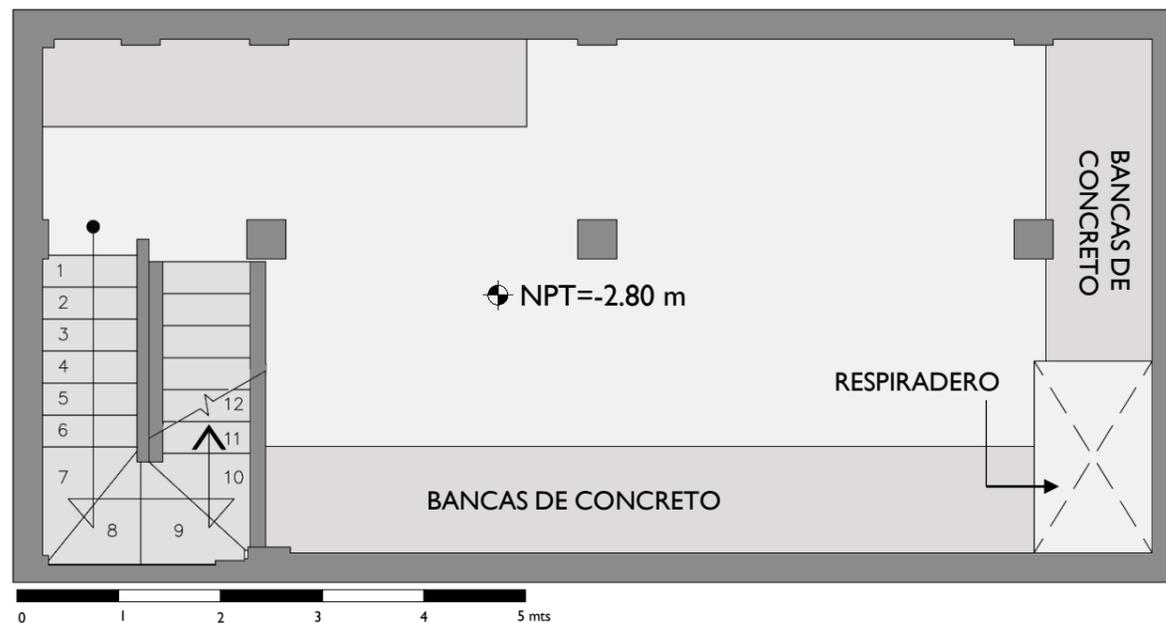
Planta arquitectónica sótano. Fuente: propia.
